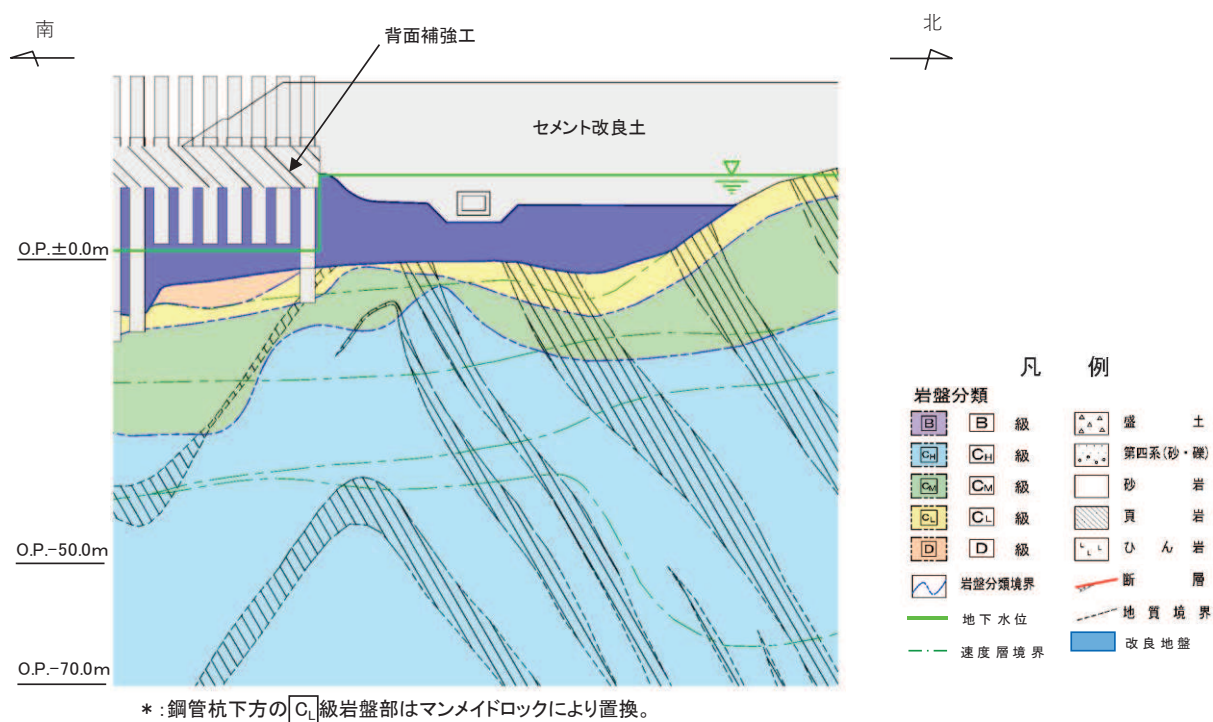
北側排水路の評価対象断面図 (A-A 断面)
